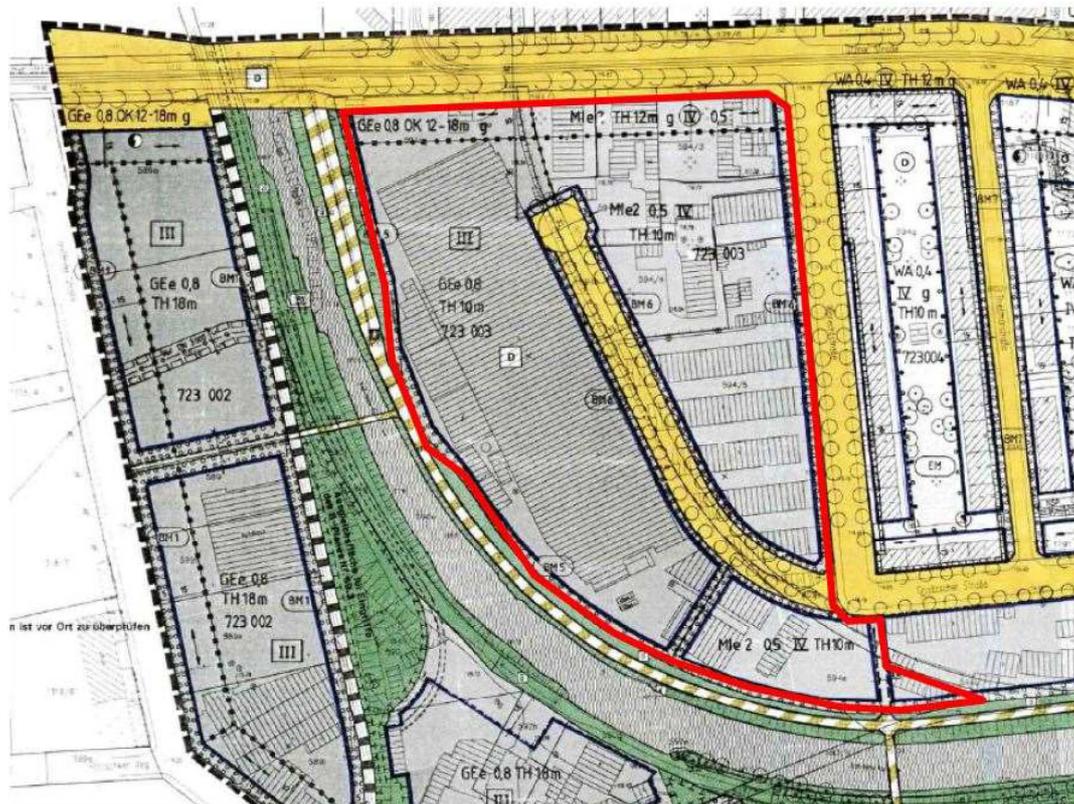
Auszug Planzeichnung: B-Plan Nr. 022.2 „Am Kanal“
